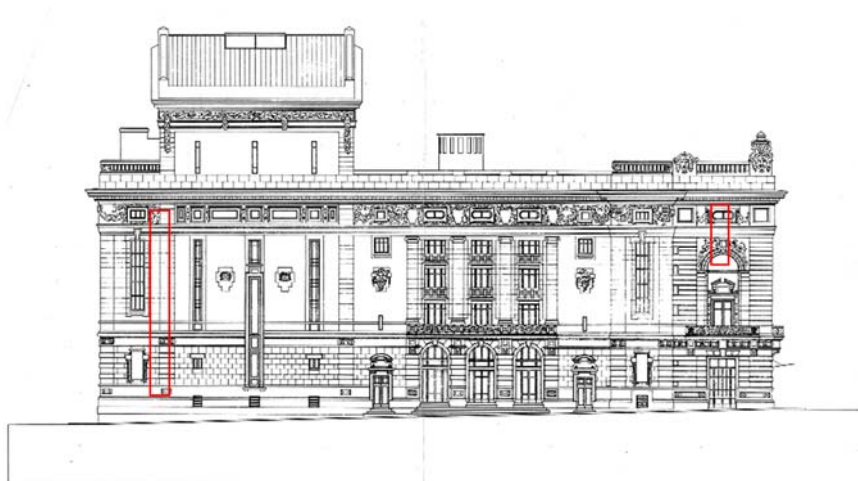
Alçado Nascente: Localização de fissuração estrutural.
